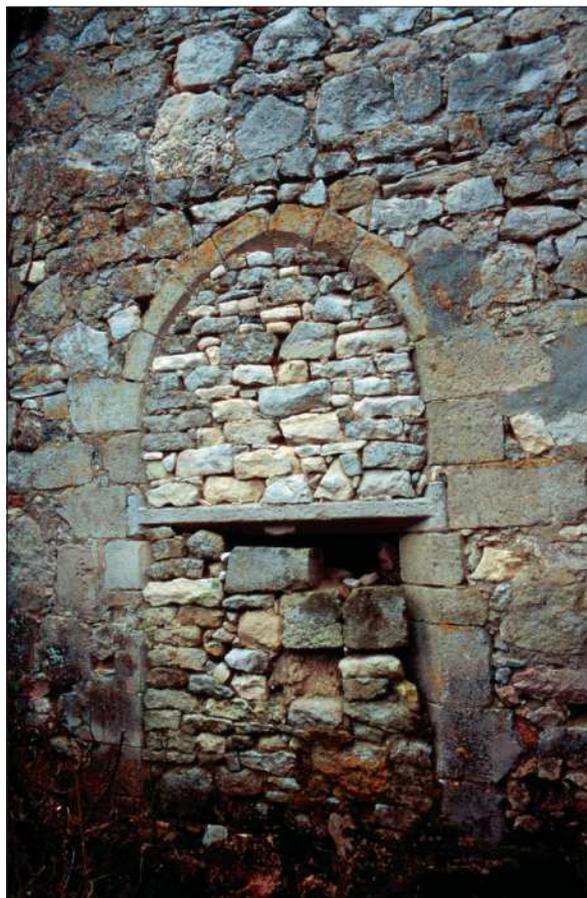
Montaon, détail extérieur d'une des fenêtres du mur gouttereau ouest du bâtiment médiéval, au premier niveau (photo C. Corvisier).
